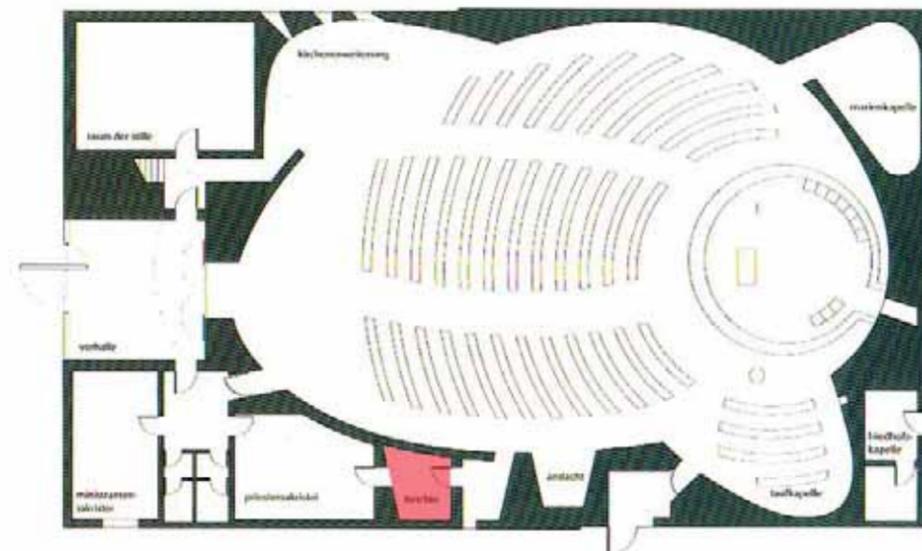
Aussprachezimmer neben Sakristei, Grundriss, St. Franziskus, Regensburg
